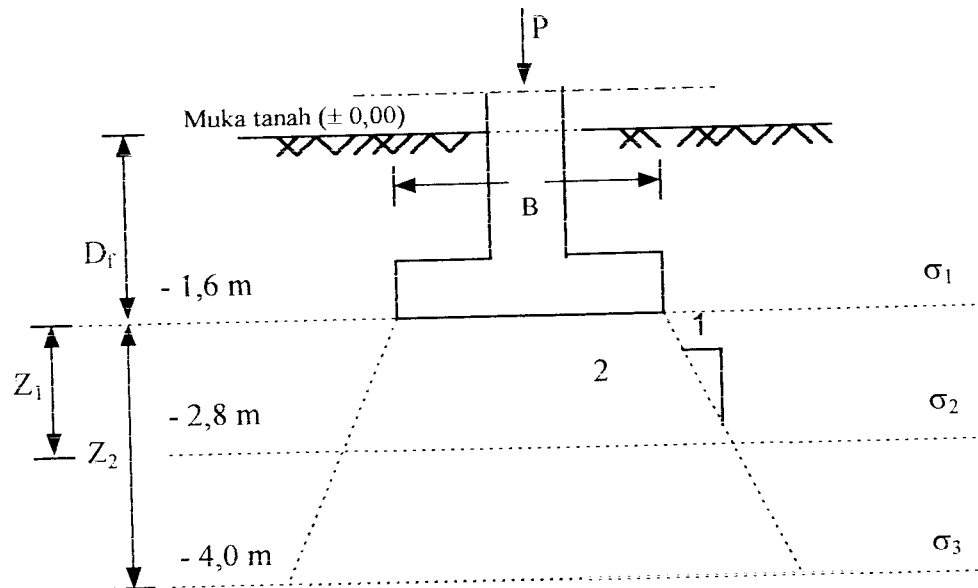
Daerah keruntuhan bidang geser pondasi
